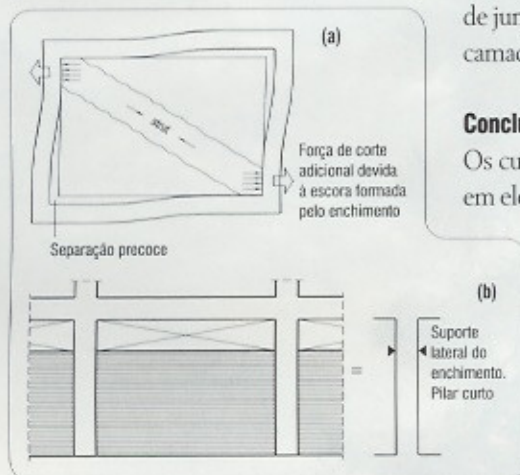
Efeitos adversos locais da interação pórtico-enchimento: (a) força adicional nos pilares; (b) pilar curto e muito sensível ao corte devido a aberturas longas
